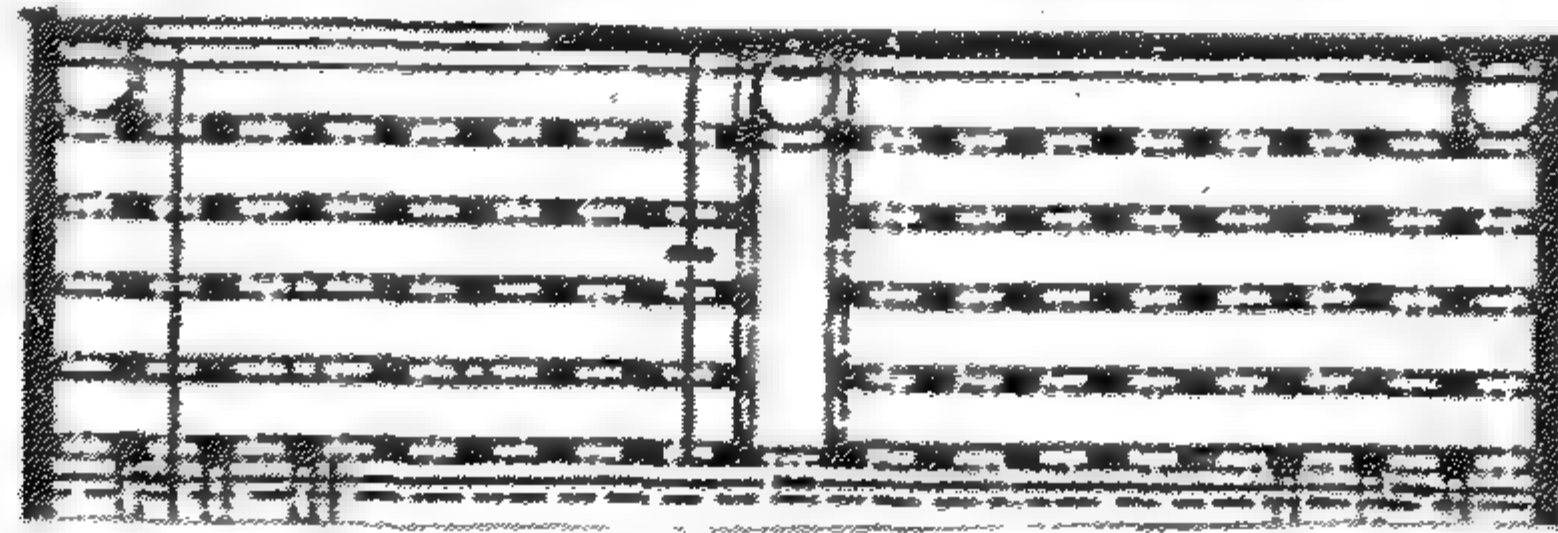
مسقط أفقي لظلة قبلة جامع الأزهر عند التأسيس ( عن كريزول )
